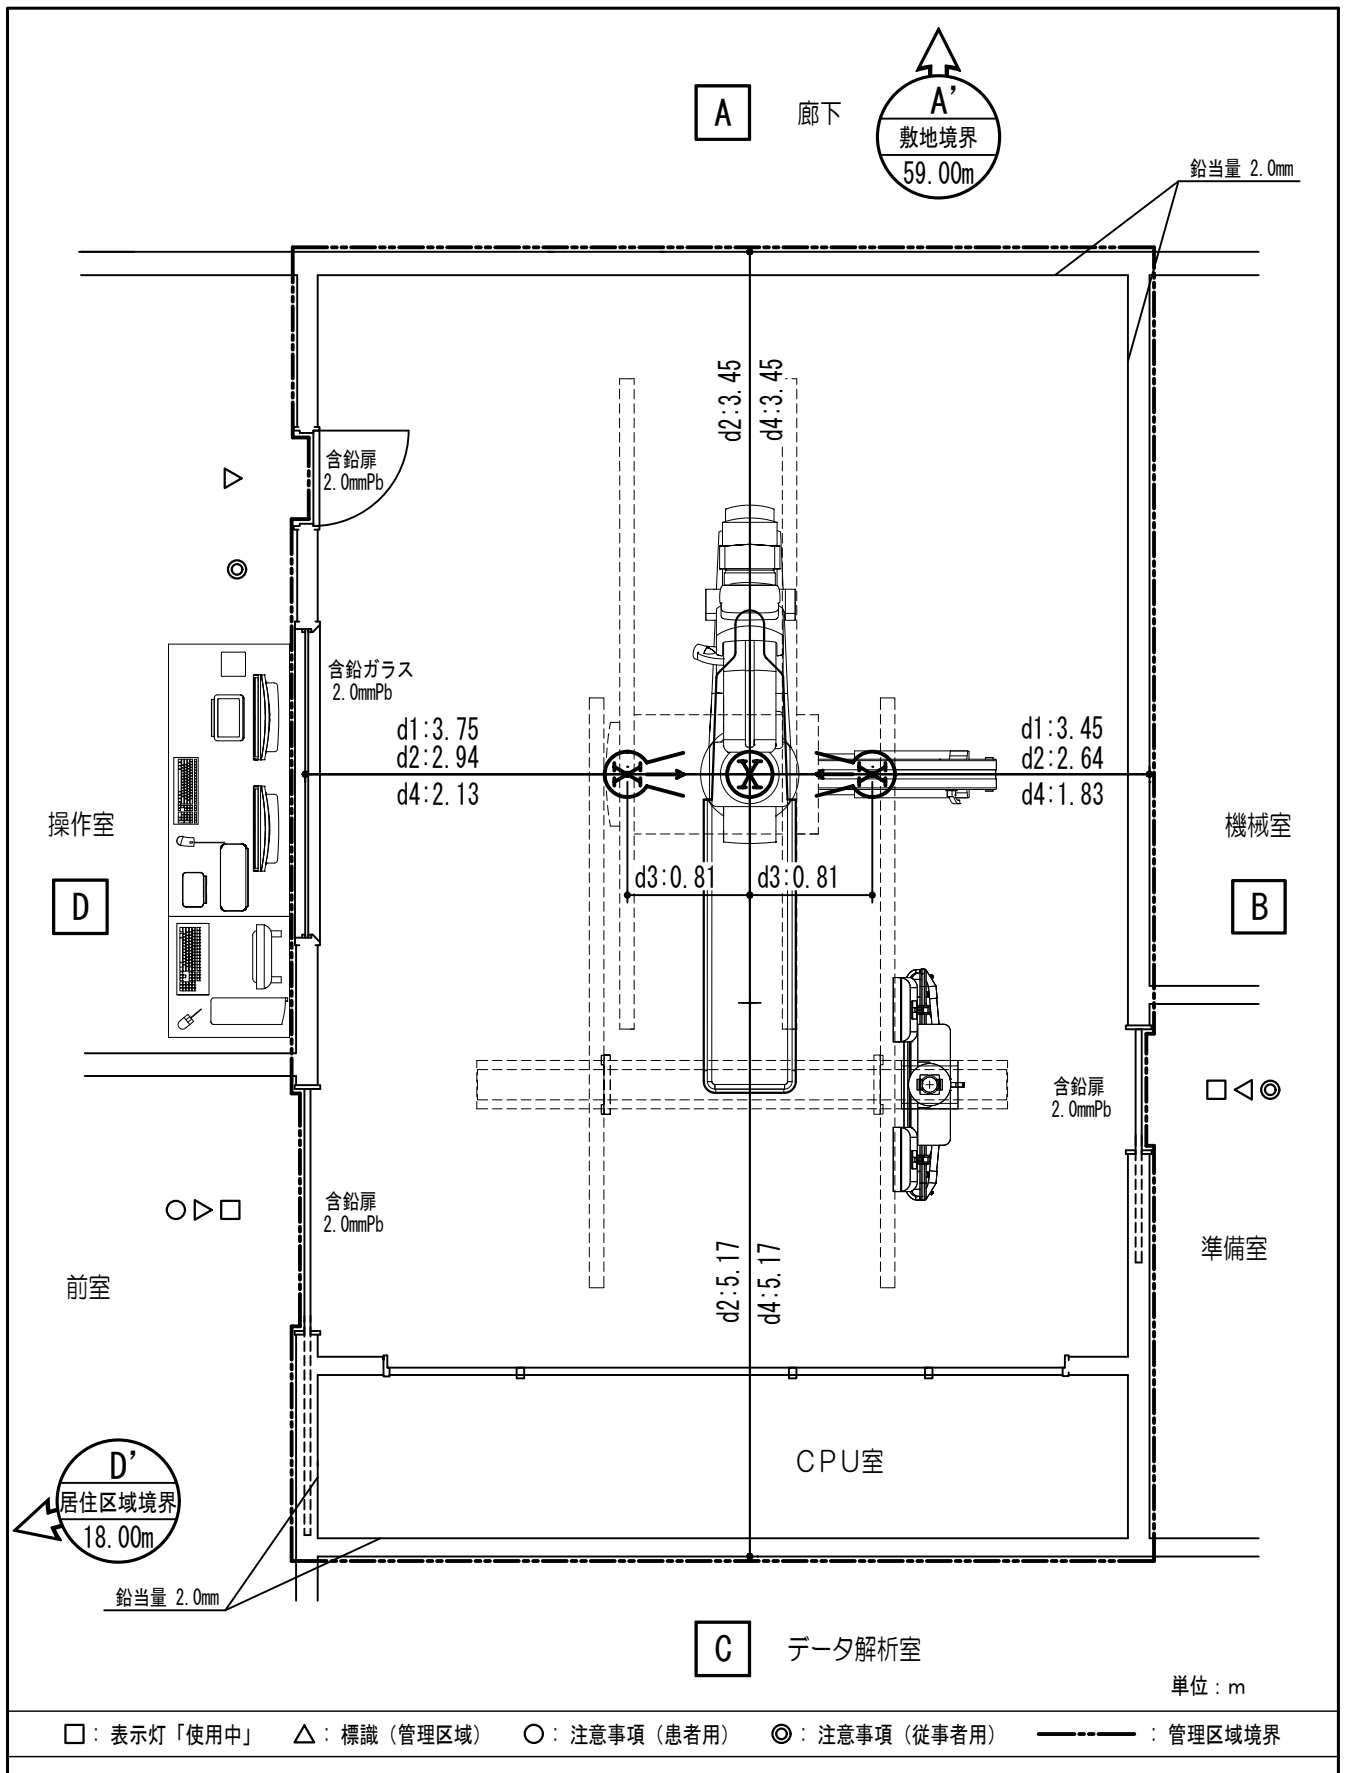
循環器用X線診断装置 床置き管球 透視・撮影 平面図
